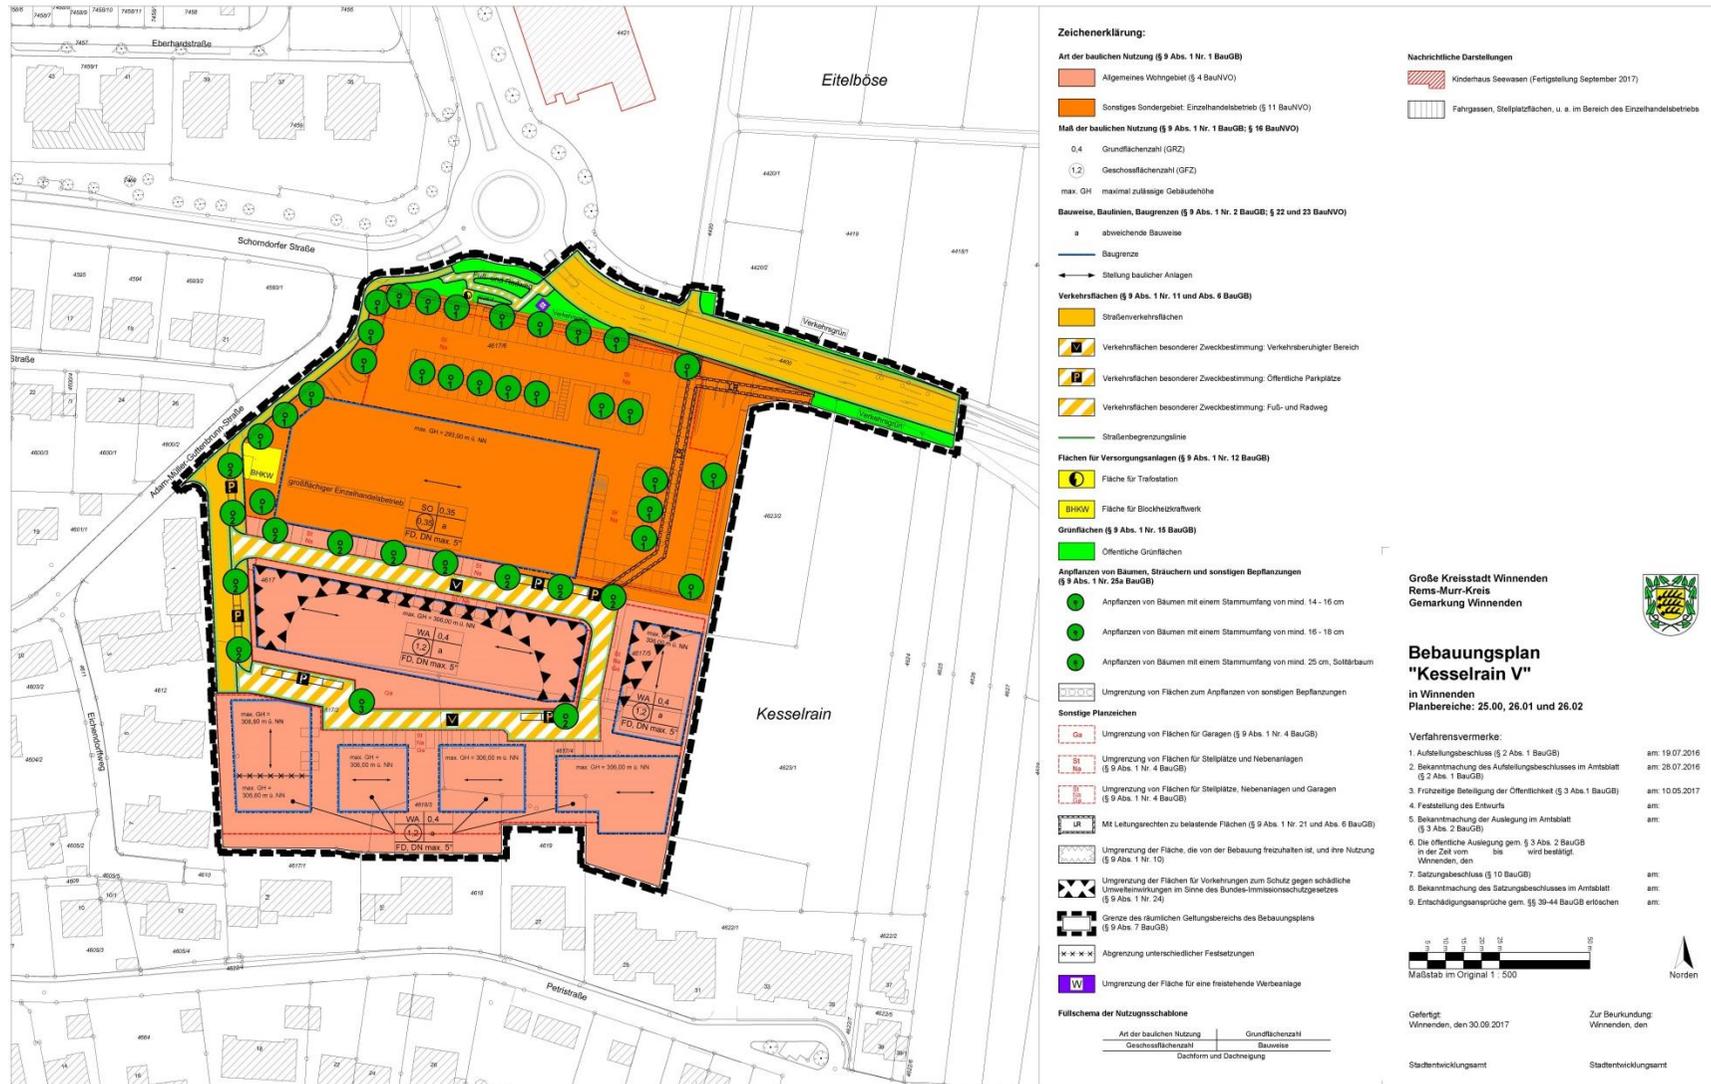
Bebauungsplan Kesselrain V, Stand 30.08.2017, unmaßstäblich (STADT WINNENDEN 2017)
